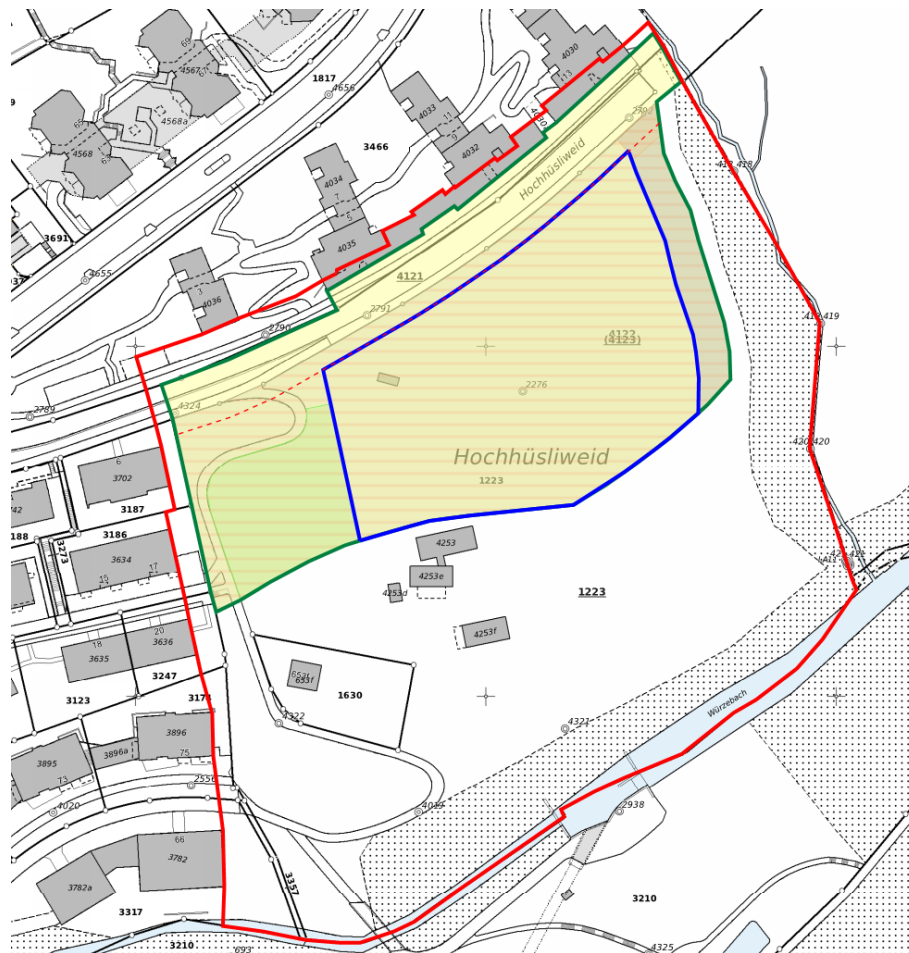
Betrachtungs- / Freiraum- und Bauperimeter sowie Perimeter Gestaltungsplan
